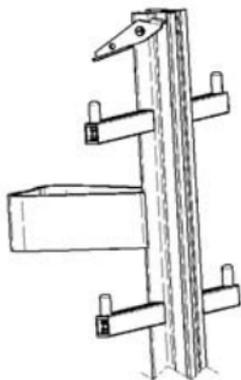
Ejemplo escalera de aluminio de un larguero con tope final móvil
